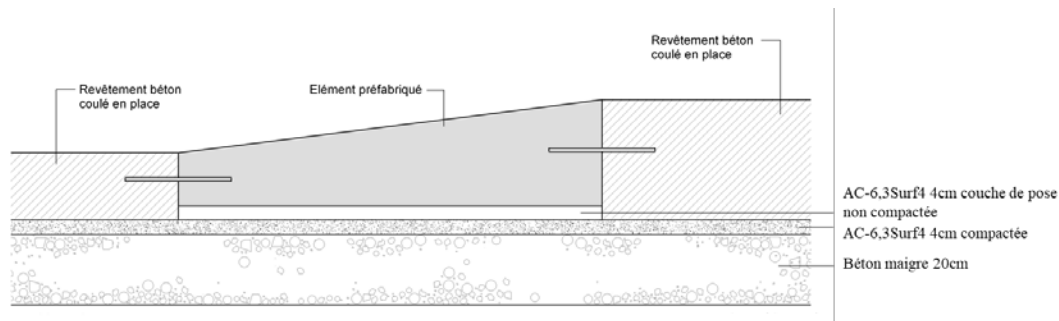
Ancre d'un élément préfabriqué (posé sur une couche de pose en enrobés bitumineux non compactée) dans le revêtement contigu en béton coulé en place
